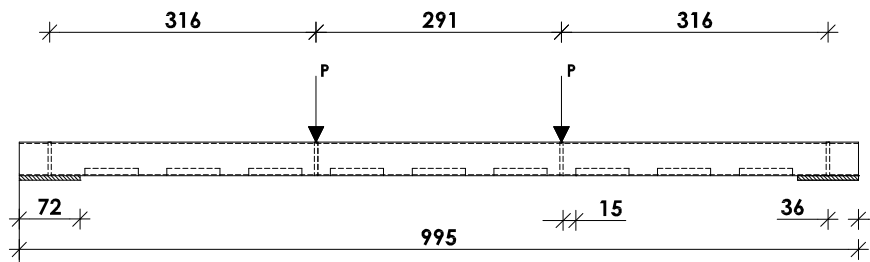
Alçado do ensaio tipo 90×1.5\_Fz1\_Furos (dimensões em mm).
